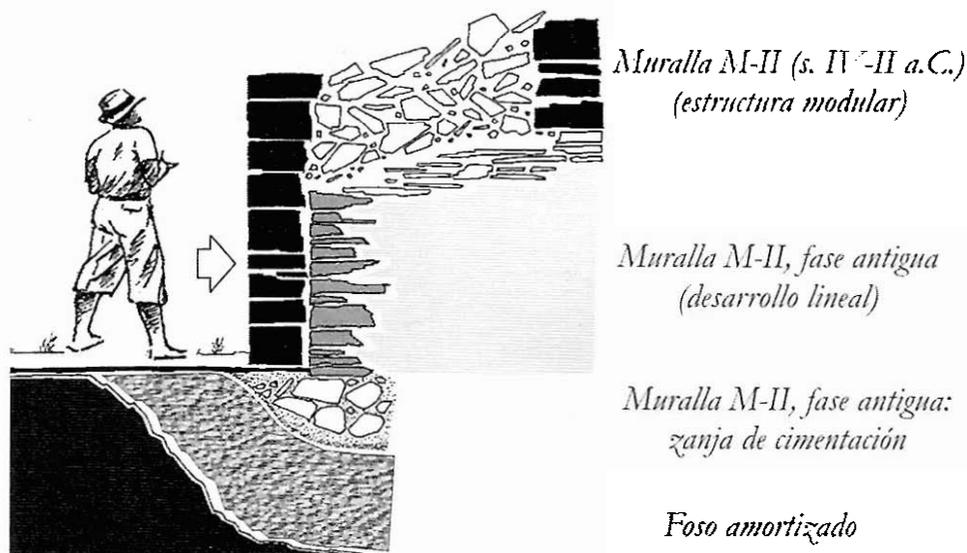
Chao Samartín. Estructura de la muralla modular del siglo IV a.C. y boceto para su instalación recubriendo otra estructura anterior.
